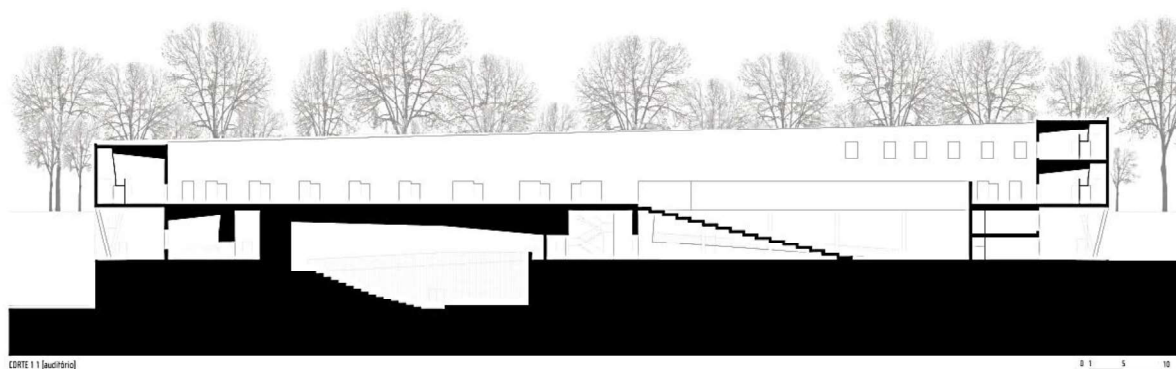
Corte Longitudinal. (Fonte: Open Buildings, 2013).
